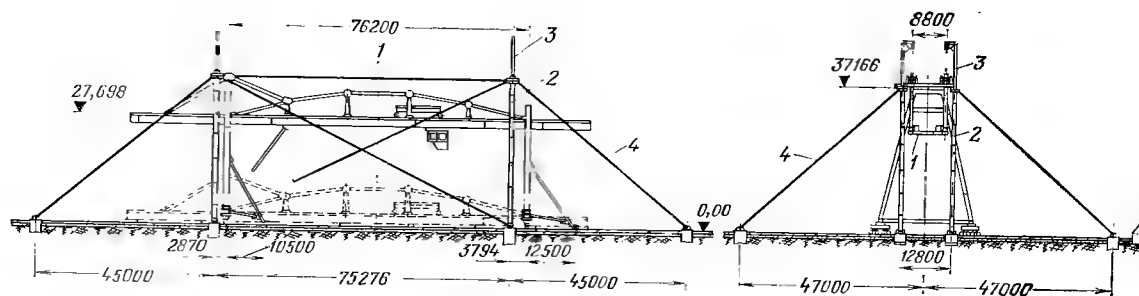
Схема монтажа крана перегрузчика при помощи гидроподъемника.
